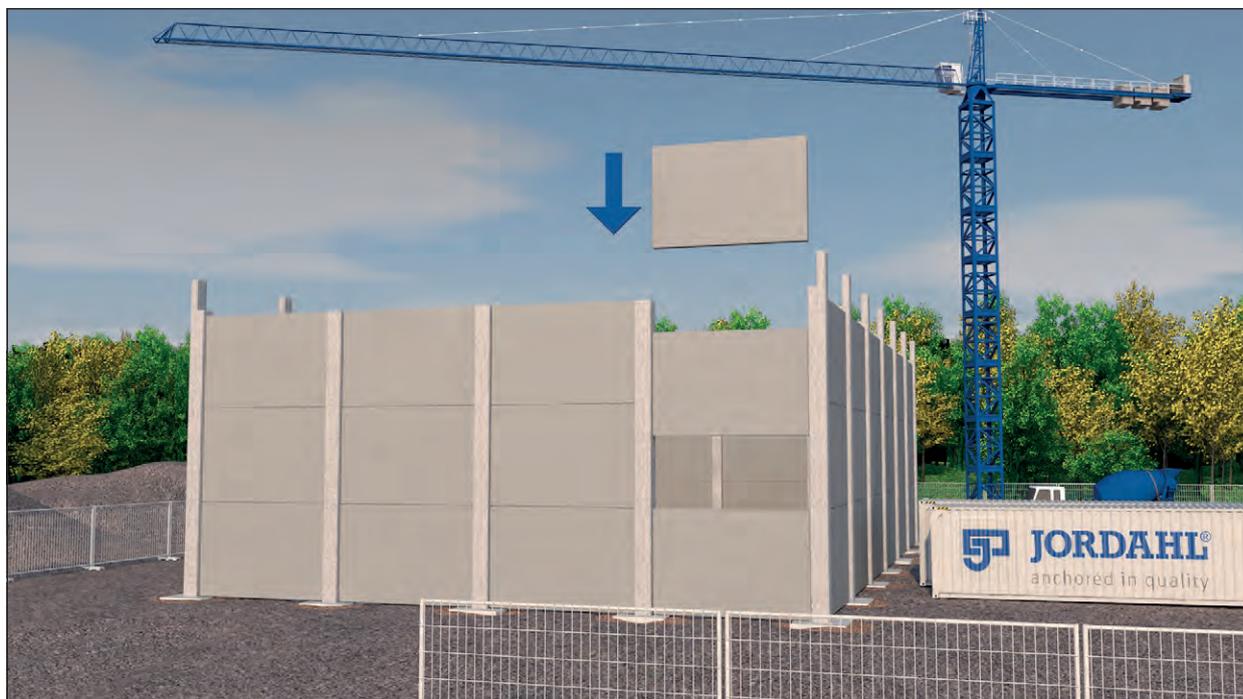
Restliche Wände, Deckenstreben und Dach „fliegen“ von oben ein. Die Halle wird fertig gebaut.
